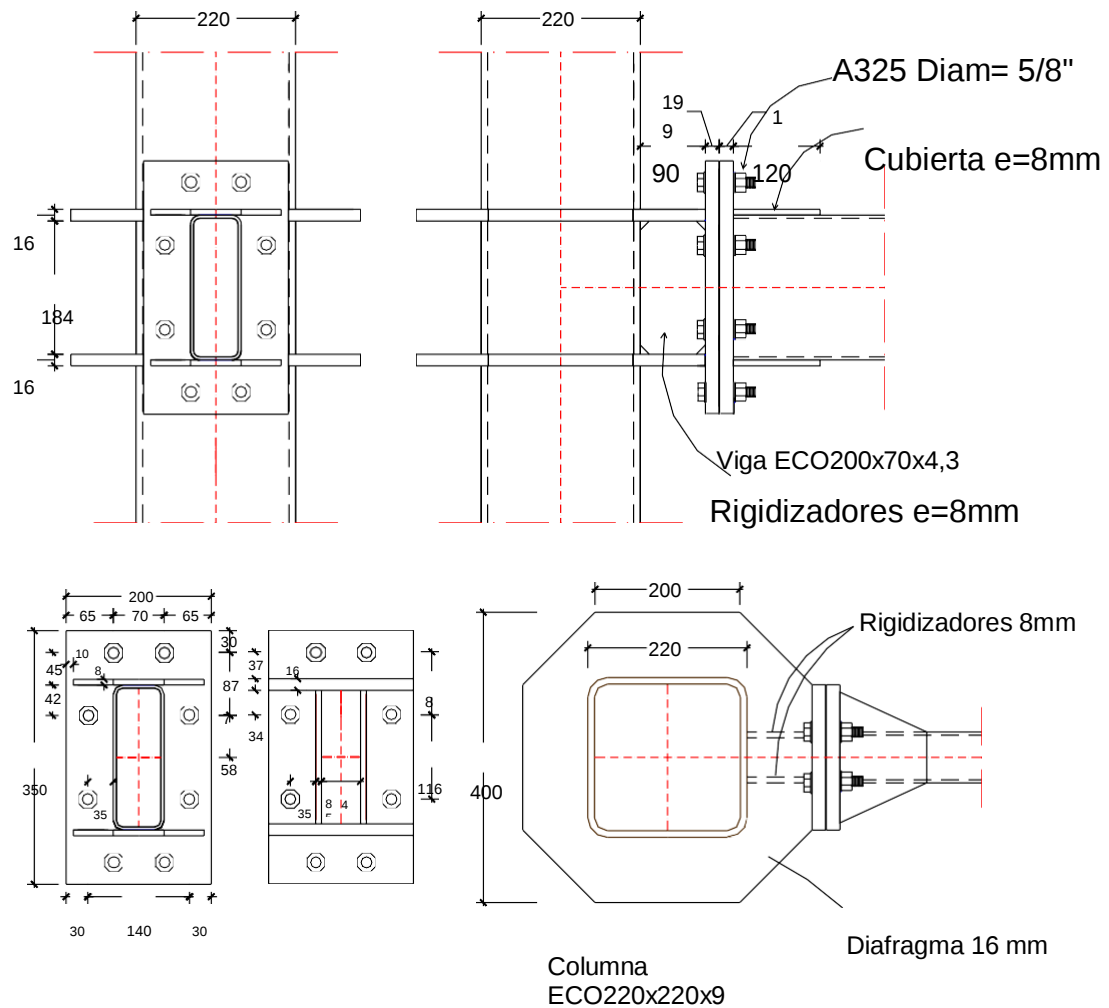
Detalles de la conexión a momento viga-columna entre perfiles tubulares investigada
